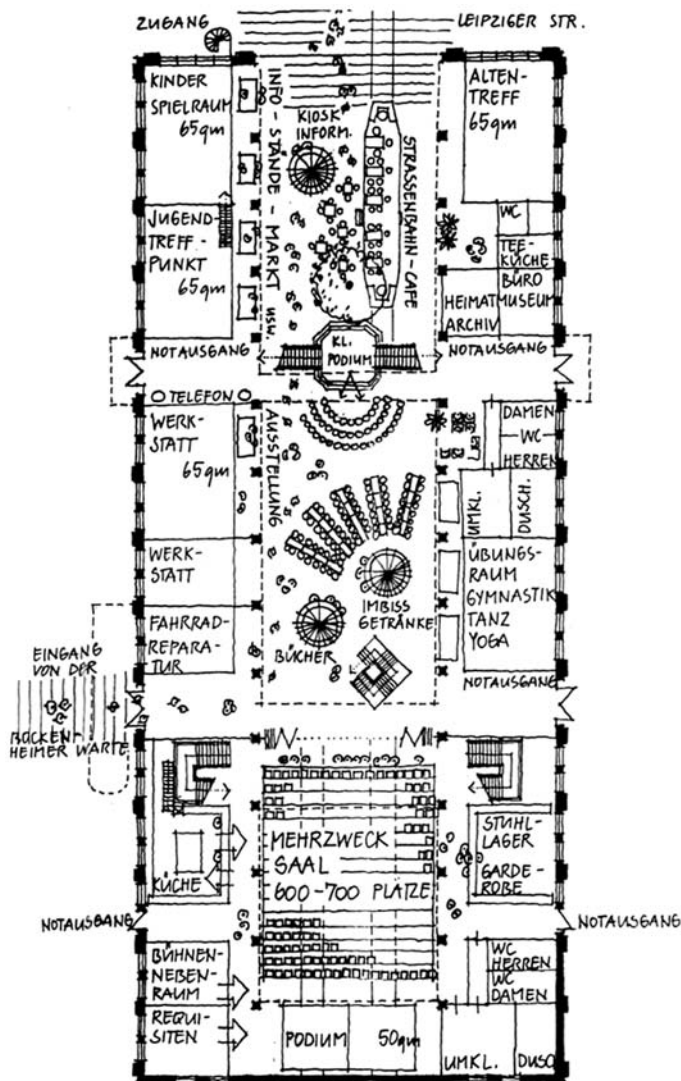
Bockenheimer Depot, Frankfurt/Main, Projekt, Grundriß Erdgeschoß
